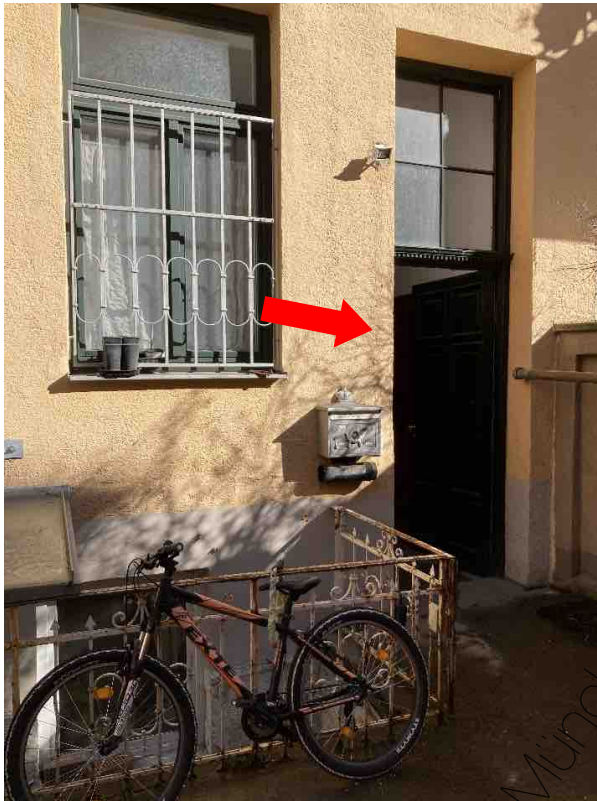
/Foto 14: Zugang zum Vordergebäude über den Hof
